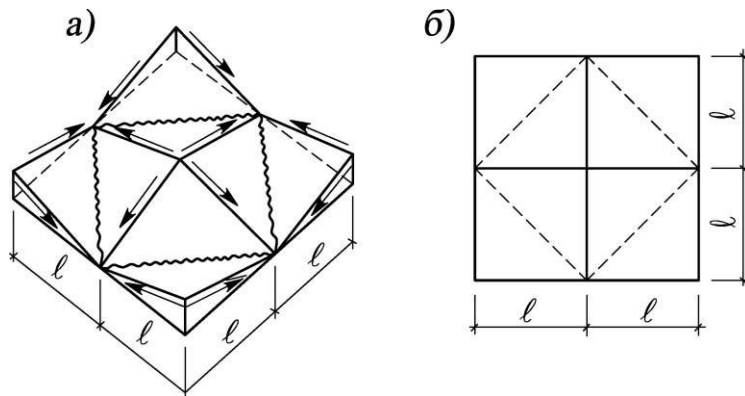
Схема покрытия в форме четырехлепесткового гипара: а – общий вид и схема разрушения; б – план покрытия
